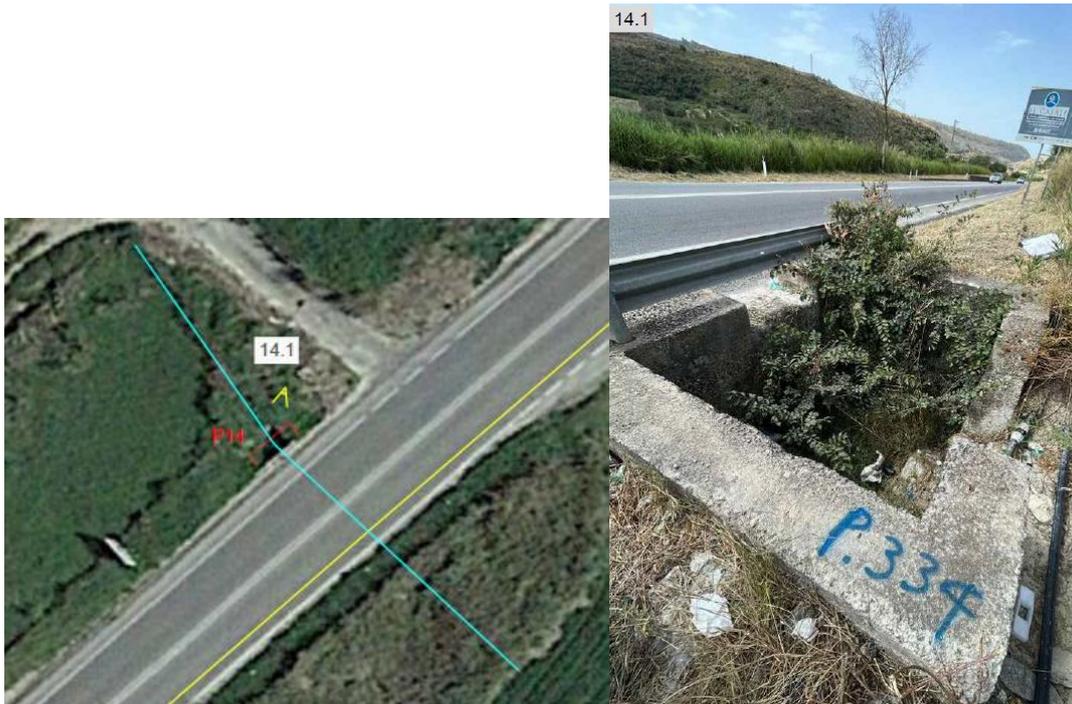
Attraversamento n. 14 - Stralcio su ortofoto e foto
